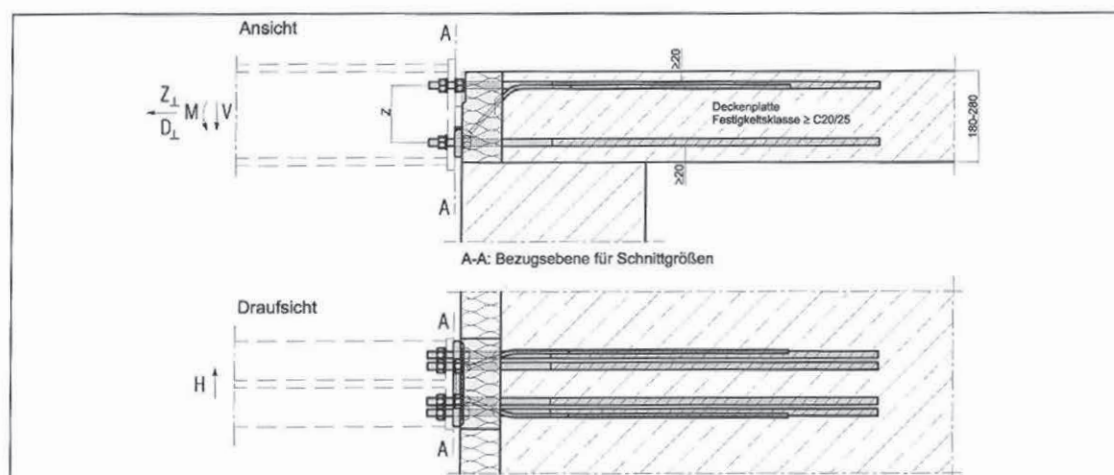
und 56: Schöck Isokorb® Typ KS14 VV, Schnittgrößendefinition
